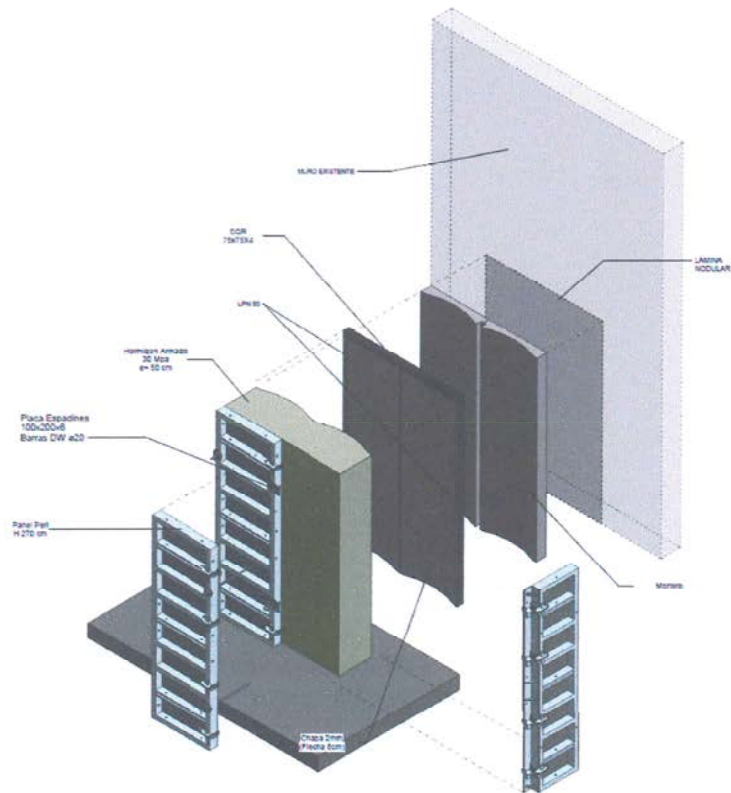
Detalle de armadura de borde y fijación a muro perimetral
